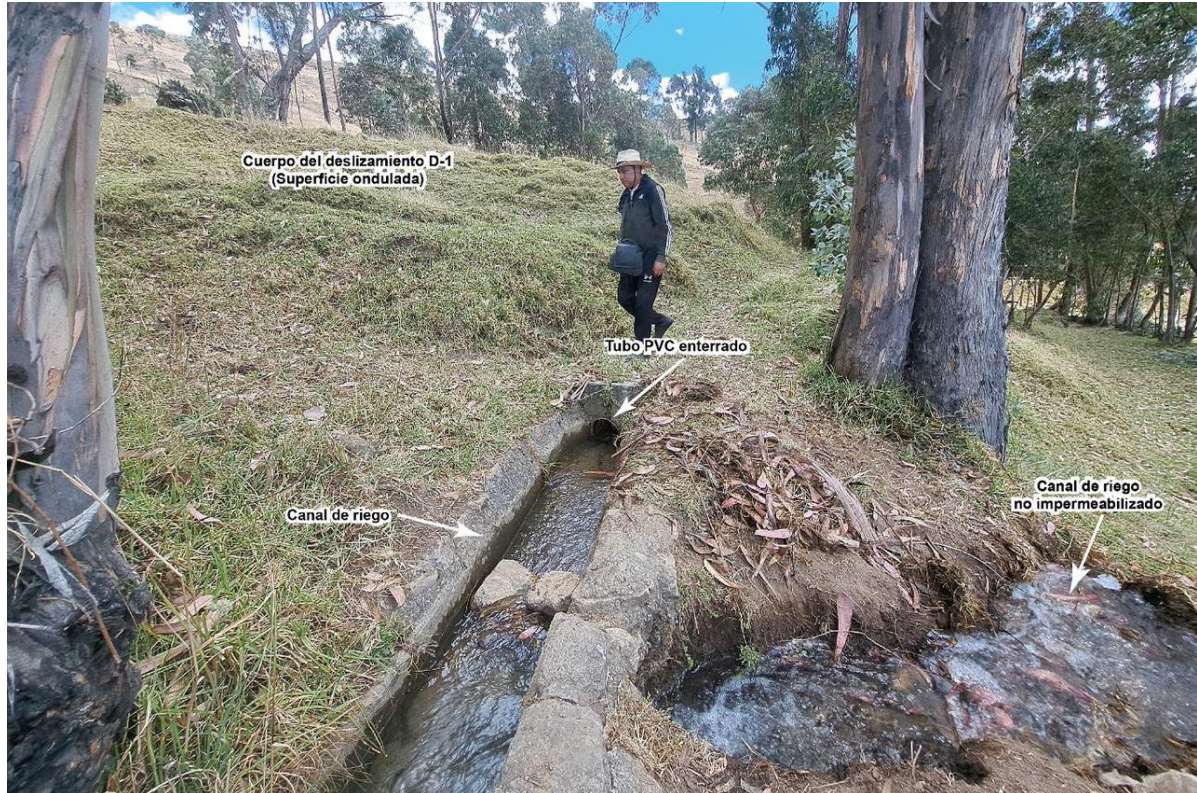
Vista de canal de riego en mal estado y conexión de tubería PVC enterrado, ubicado al pie del deslizamiento D-1.
